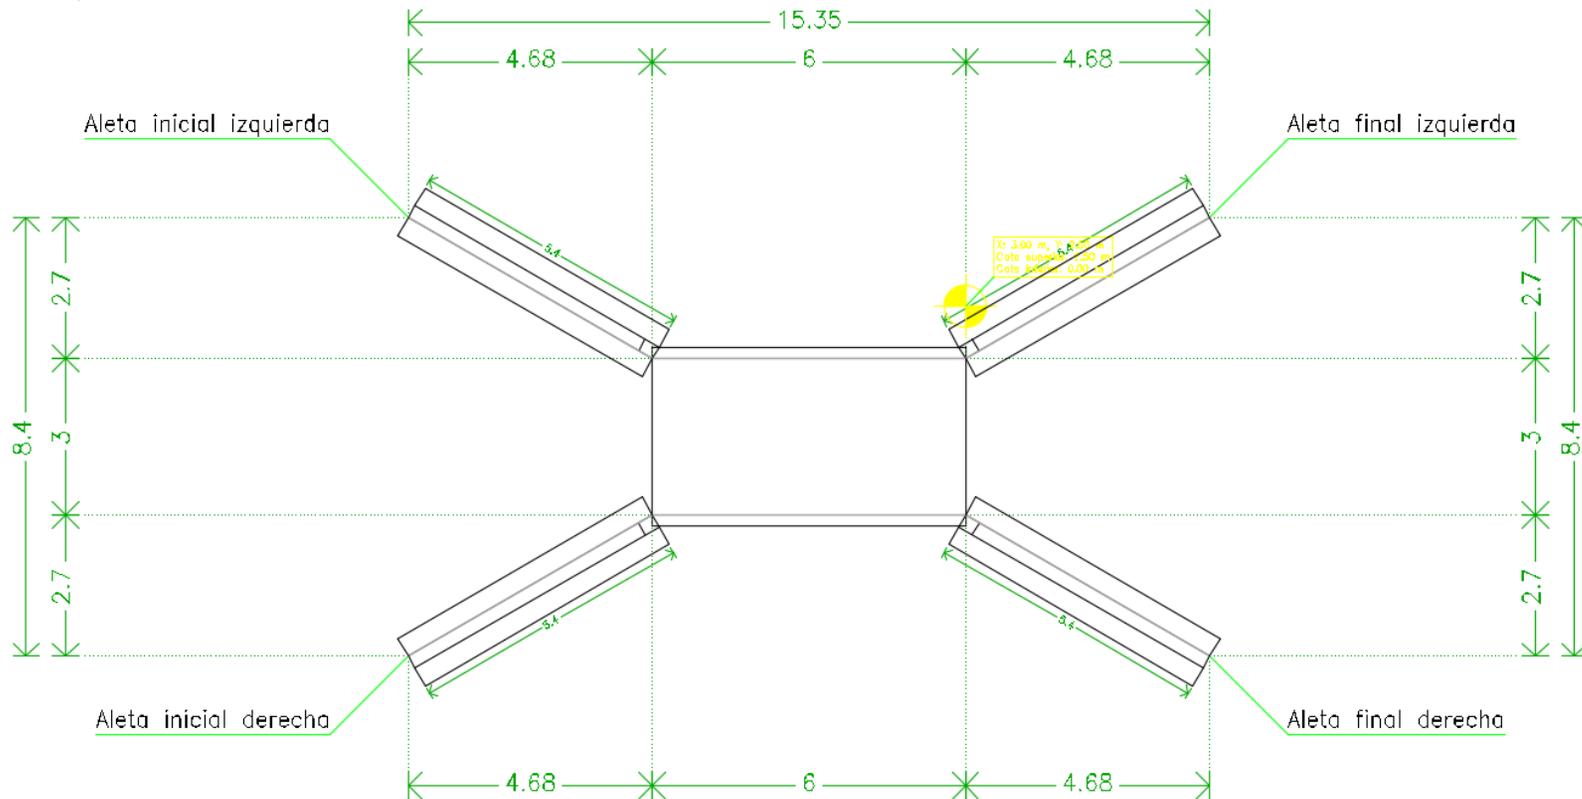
Vista en planta Box-Culvert “El Soltadero”
